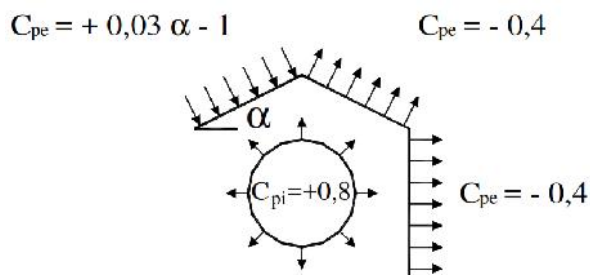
Schema di calcolo dell'azione del vento sul muro nel caso di azione agente lungo X positivo
